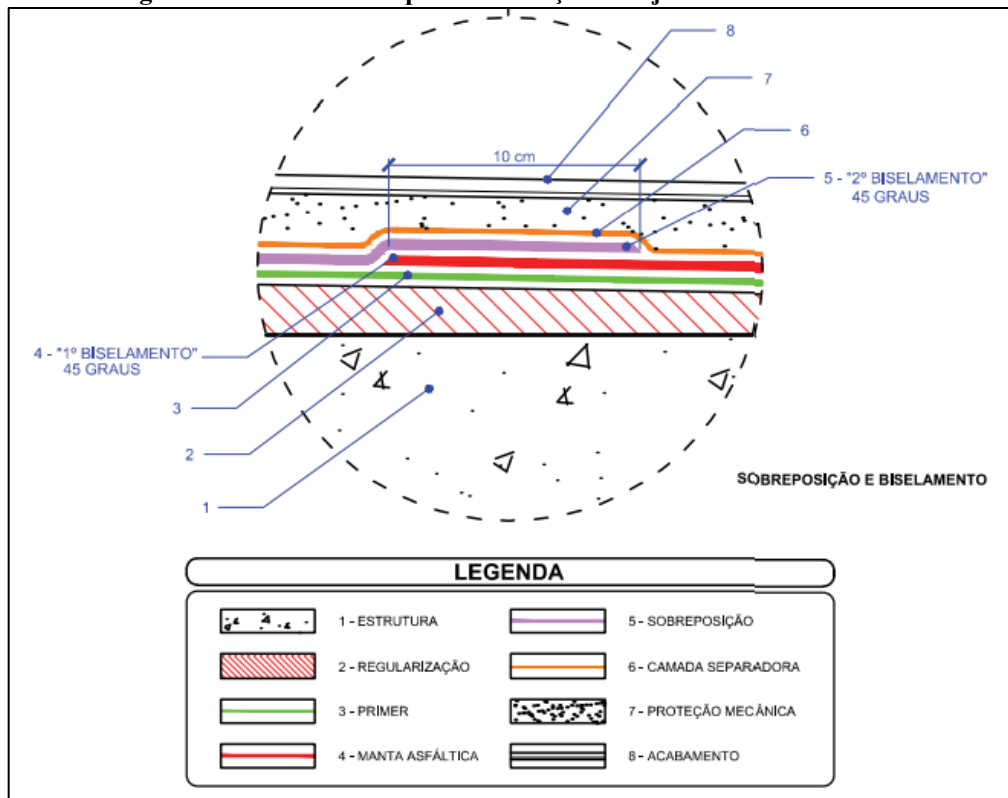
Laje de cobertura impermeabilizada com manta asfáltica
